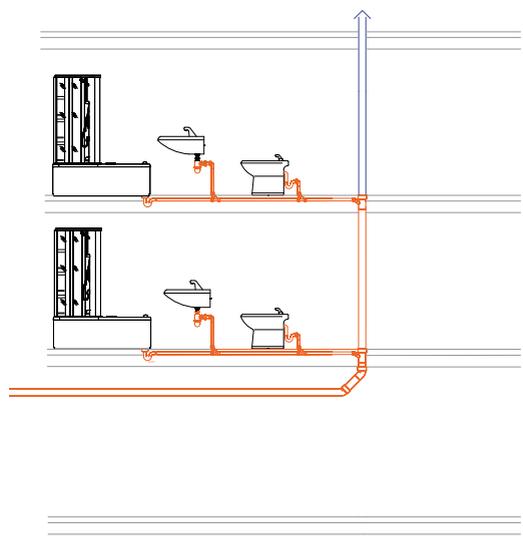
Schema ventilazione primaria per edifici fino a 2 piani e tubazione a soffitto del piano interrato
